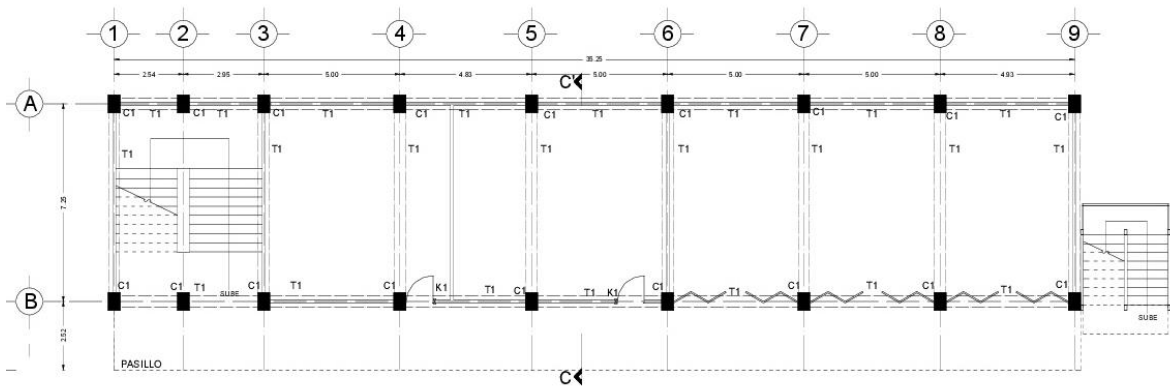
Croquis de dimensiones y elementos en planta del N2. (GACONSA, 2018)
